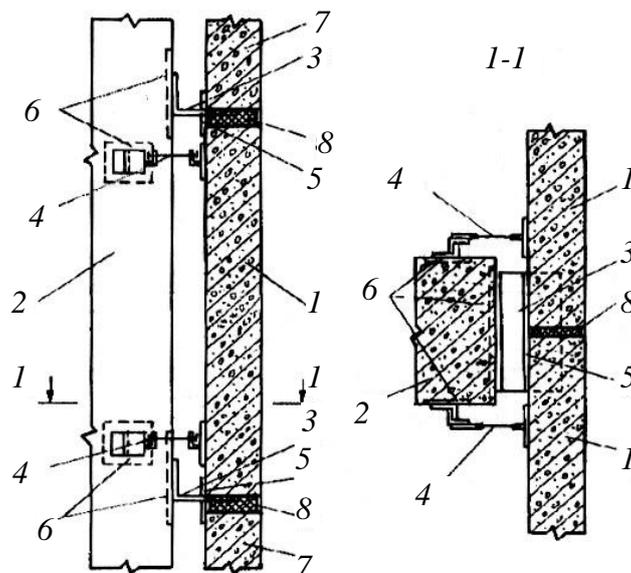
Схема крепления стеновых панелей, используемых в качестве легкобрасываемых, к каркасу здания:
